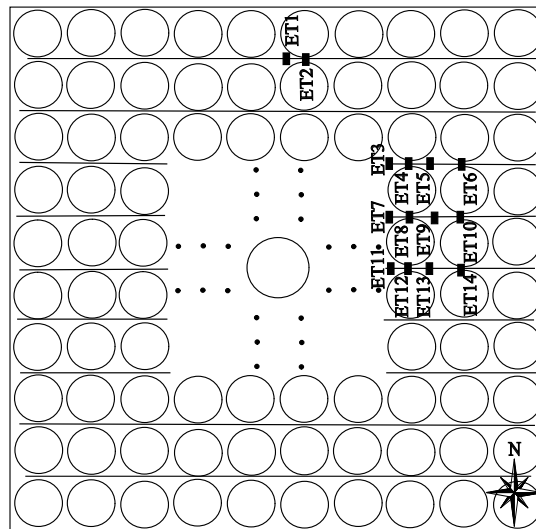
Localização dos extensômetros nas treliças da laje BD-A03
